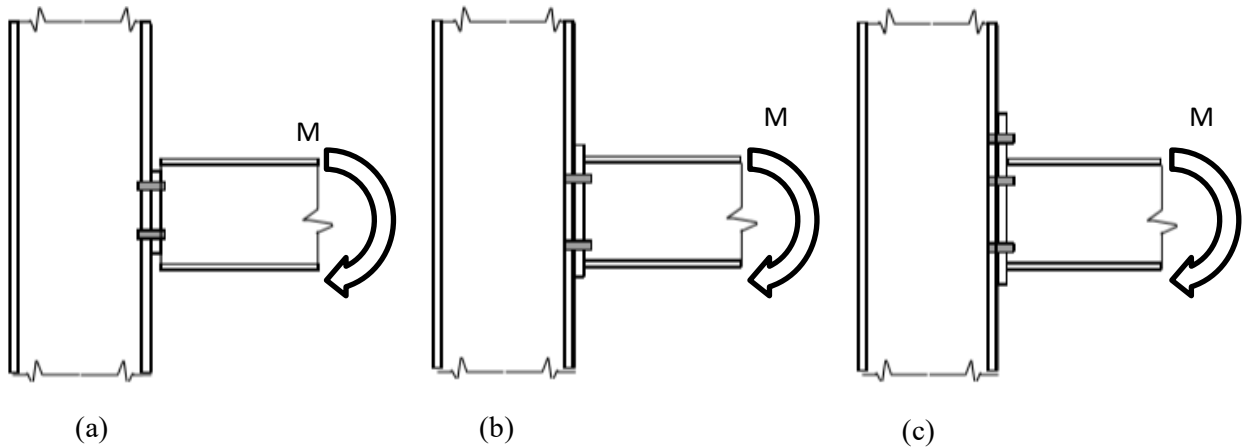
Détail d'un assemblage poteau-poutre par platine d'about boulonnée
